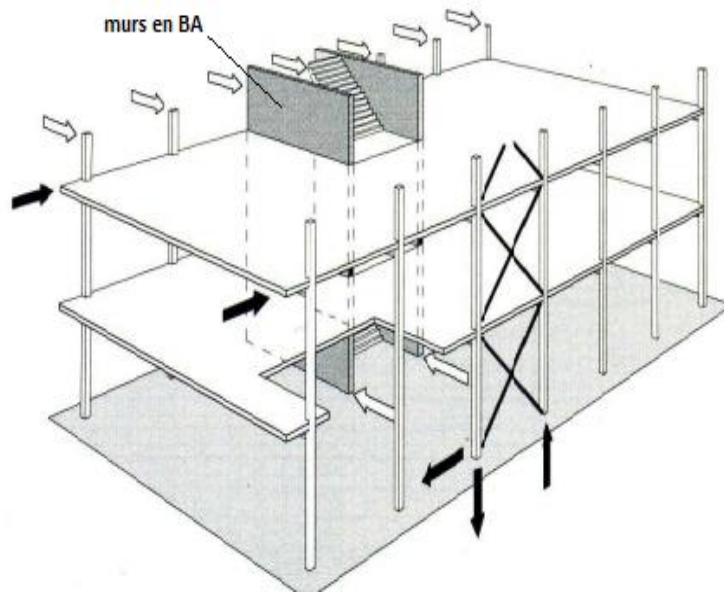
Contreventements verticaux par murs en BA [7].
